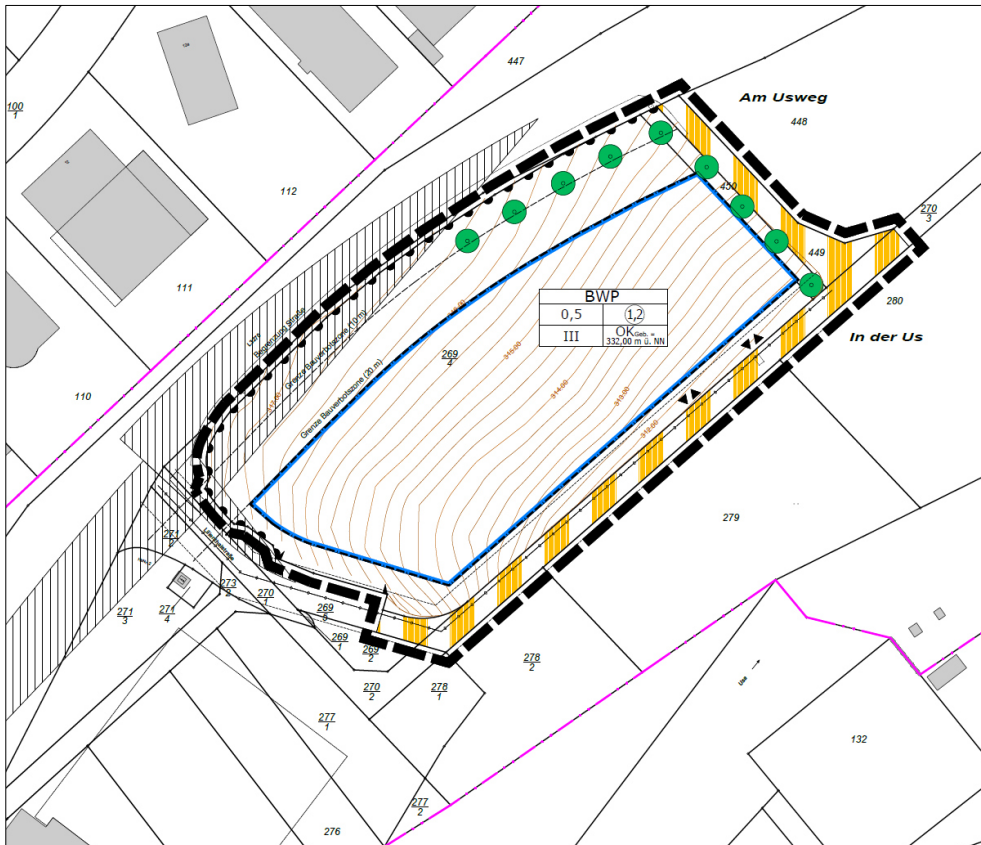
Ausschnitt aus dem Vorentwurf zum Bebauungsplan „Pflegecampus Kleeblatt“. (Plan|ES, Stand 09.07.2024)
